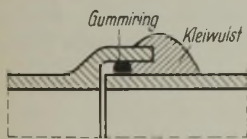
Muffendichtung der Saugleitung der Grundwassersenkungsanlage.
